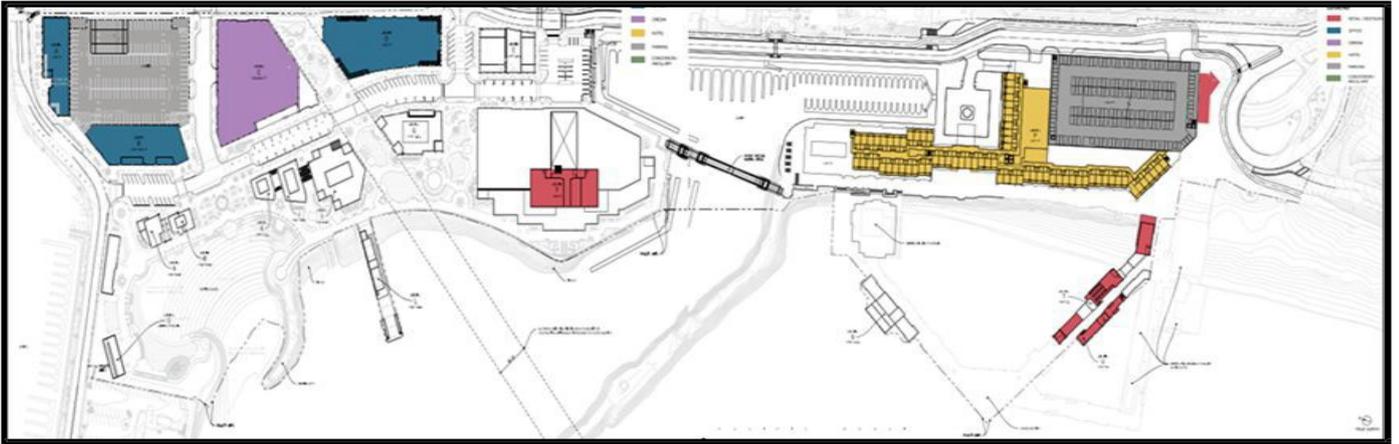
Plan niveau 02. Src: <http://www.thewaterfrontredondo.com/project-view/>.
